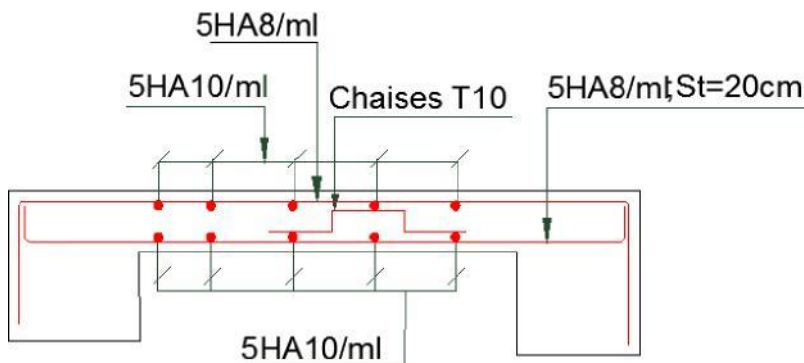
Détail de ferrailage dalle pleine sur quatre appuis.
